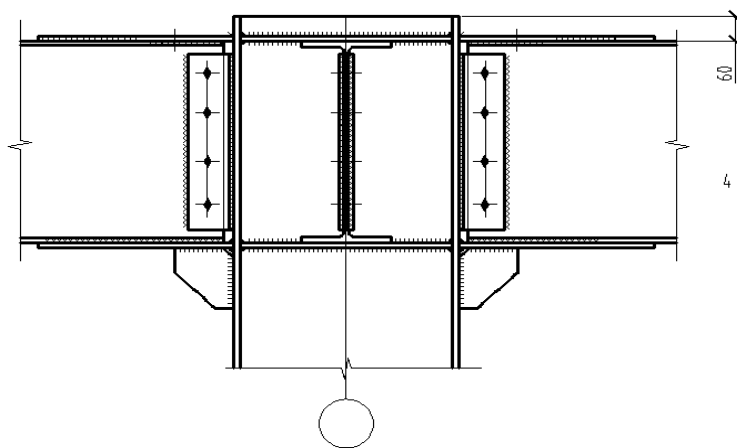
Узел сопряжения балки перекрытия с колонной
